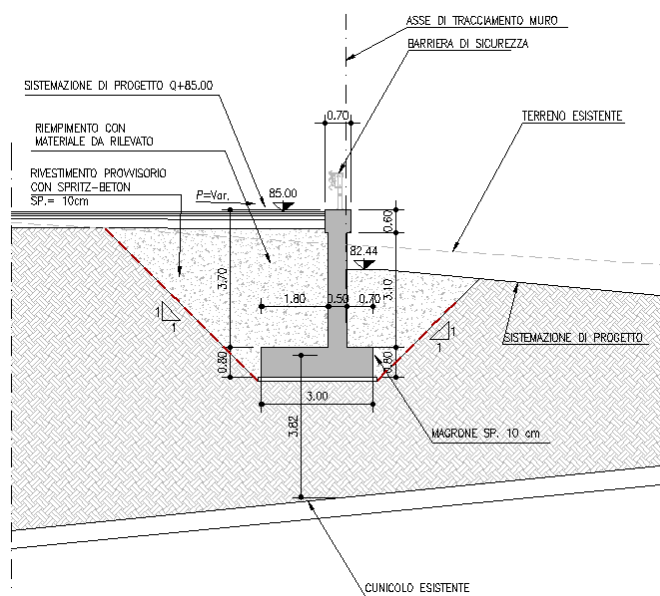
Muro di sostegno MS01 – Sezione tipo 2
